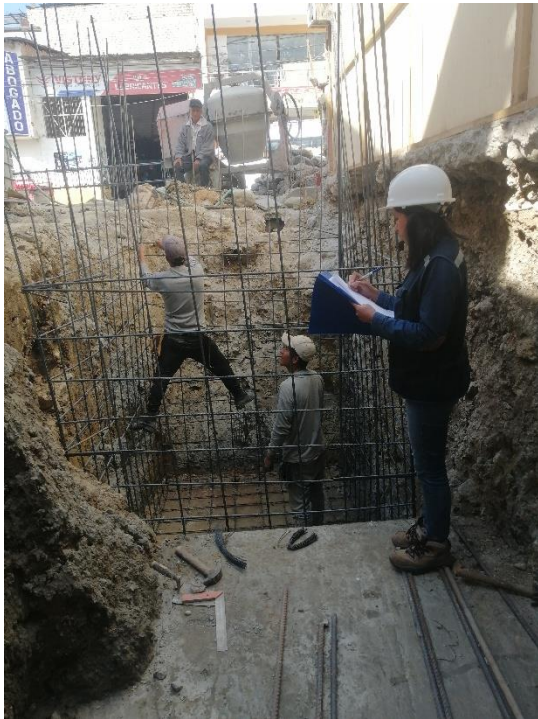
Desencofrado de cisterna en la vivienda N° 1
